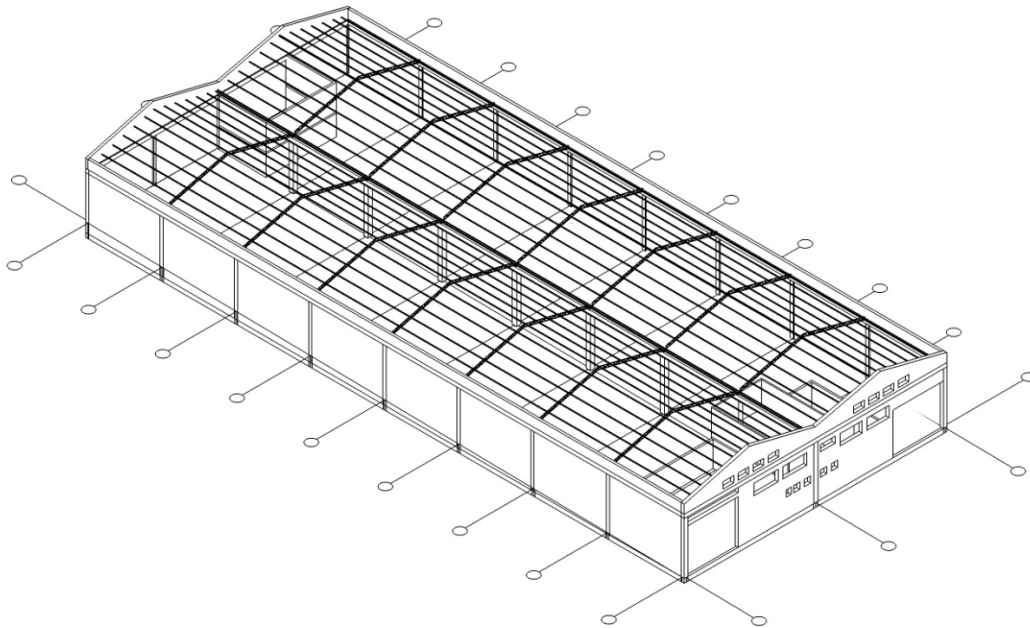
Estructura del edificio, sistema de vigas y columnas:
